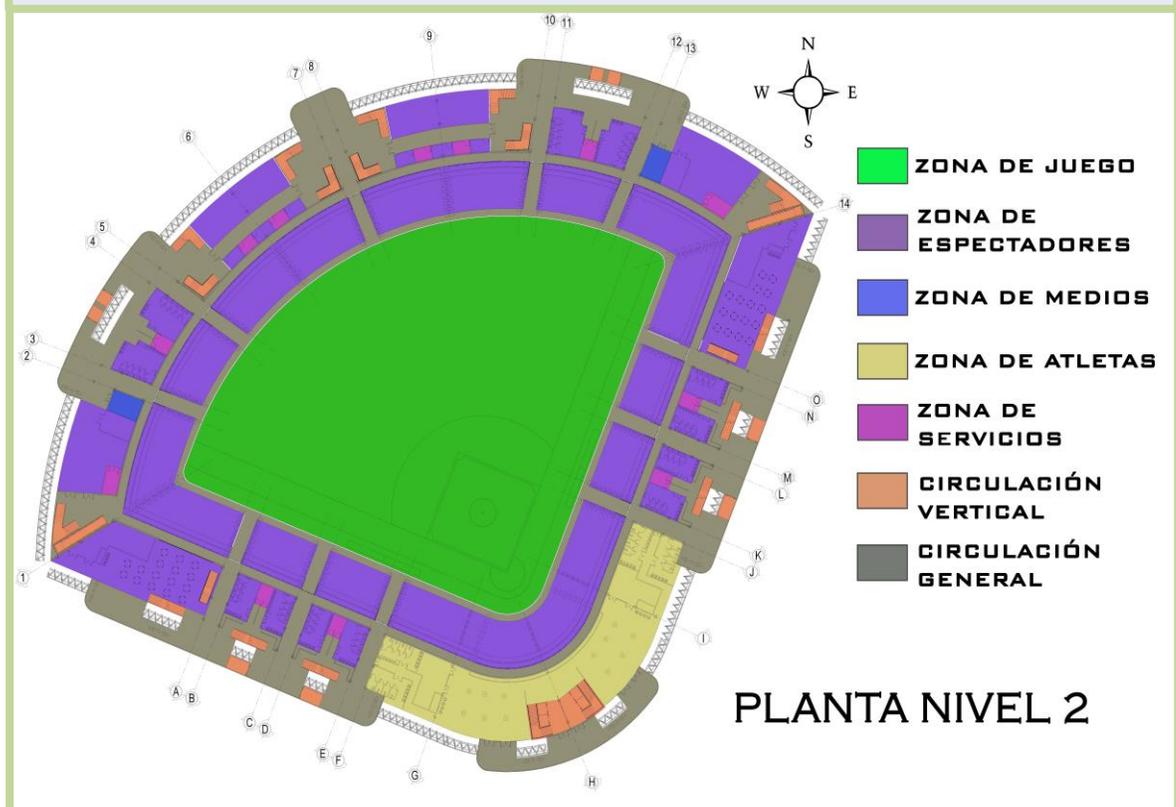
Zonificación - Planta nivel 2 - Fuente: Elaboración propia
